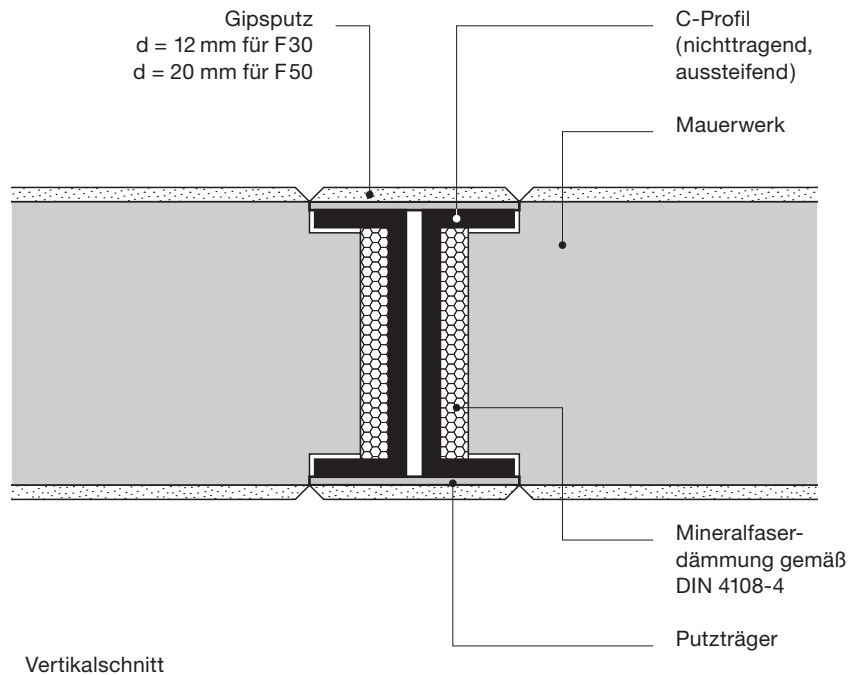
Geputzte Porenbeton-Mauerwerkswand mit aussteifendem Stahlprofil mit Putzträger, F 30-A bis F 60-A
